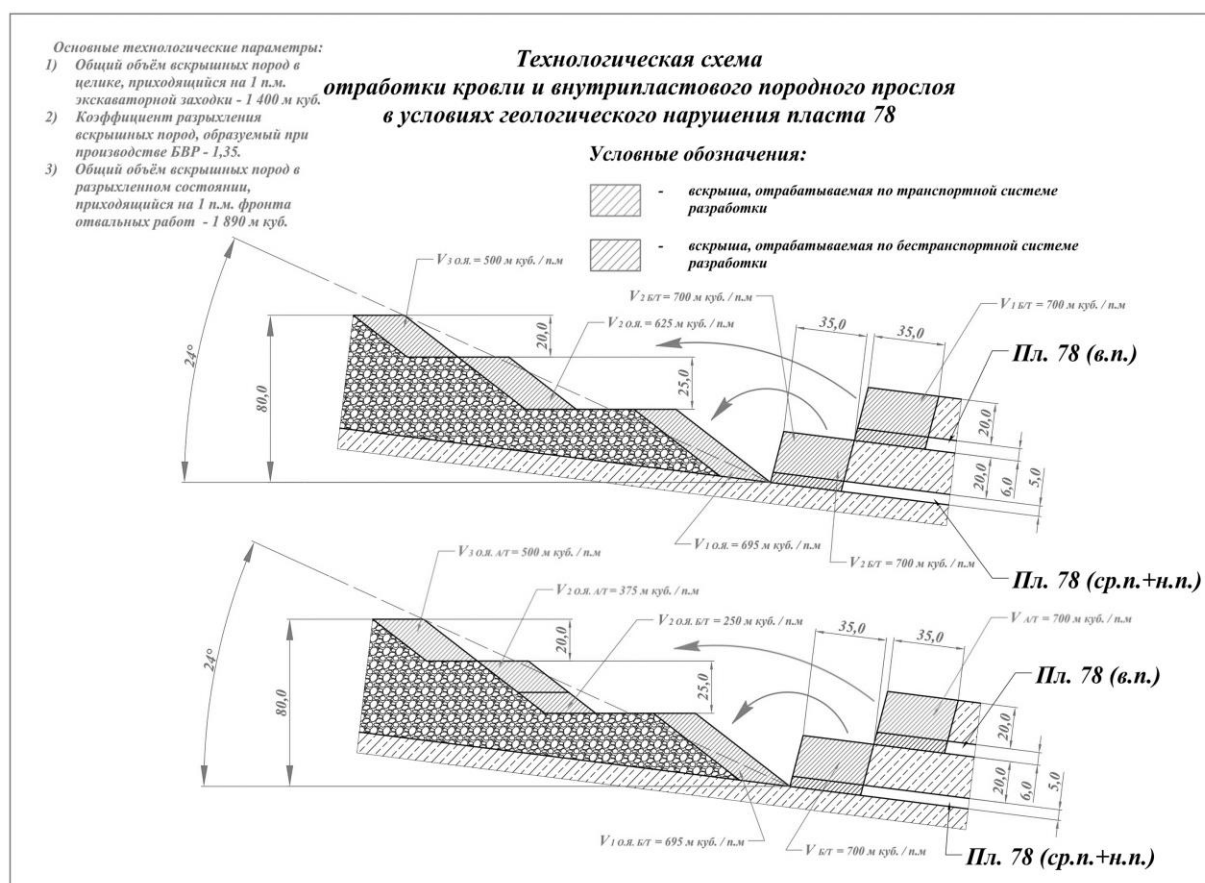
Технологическая схема отработки кровли и внутрипластового породного прослоя в условиях нарушения угольного пласта
